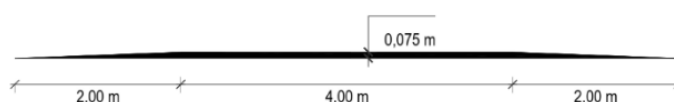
Perfil longitudinal tipo de lomba trapezoidal proposta.
